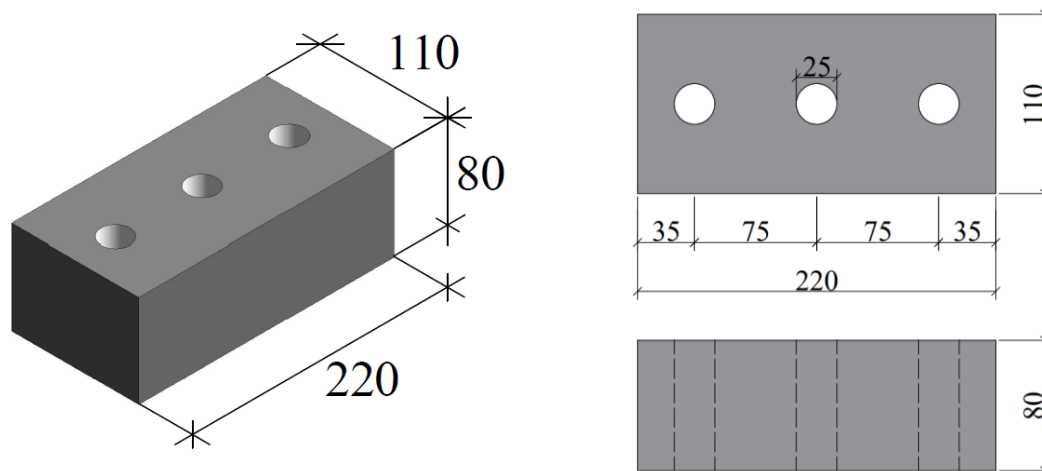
Dimensões em milímetros do bloco de solo-cimento fabricado.
